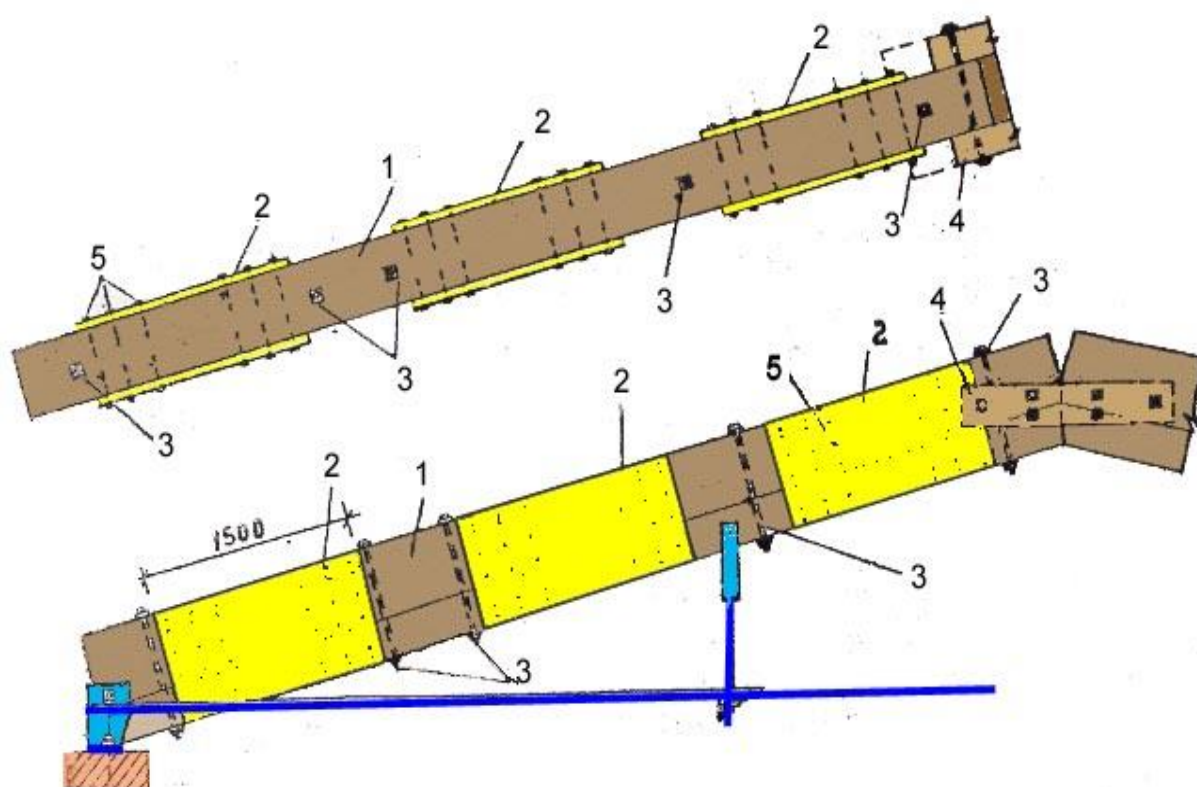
Усиление клееных деревянных конструкций: 1 – существующие стропила; 2 – фанерные накладки $t=12$ мм; 3 – стяжные болты М20; 4 – узловая накладка $t=75$ мм; 5 – гвозди 3×50 мм; 6 – клеевая прослойка.
